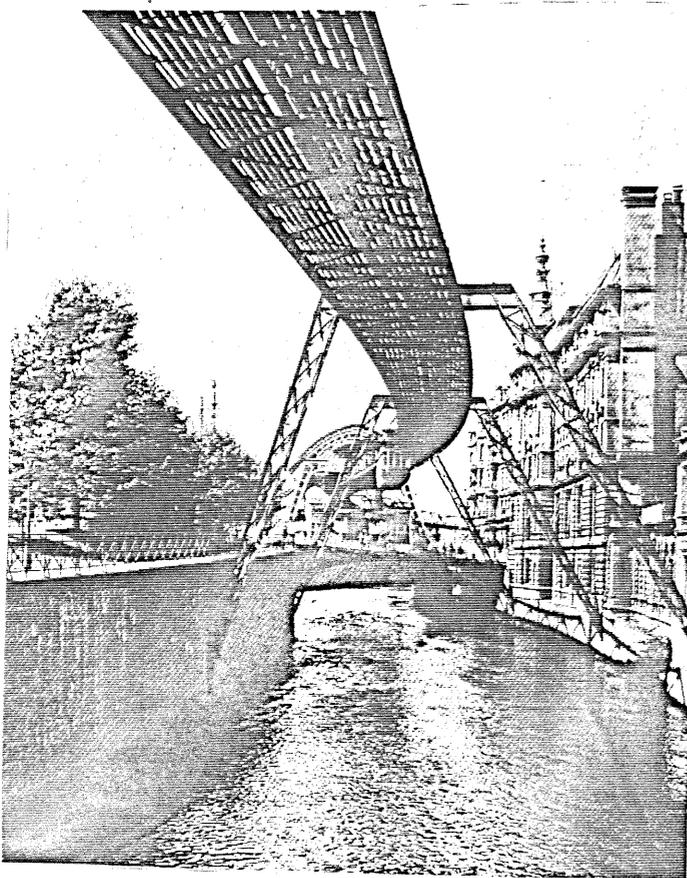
Traggerüst der Wuppertaler Schwebebahn um 1900 [1]
